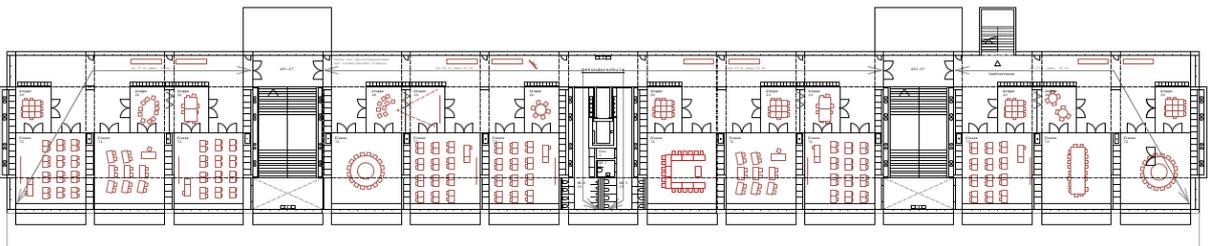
Grundriss 5. Obergeschoss
